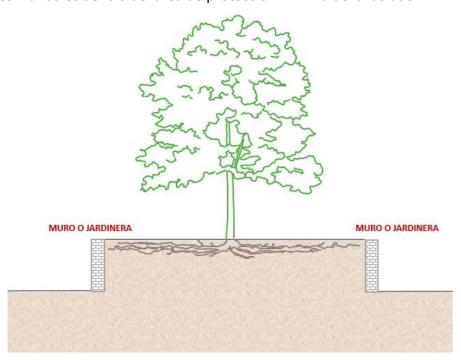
para proteger al árbol de un rebaje del terreno se debe construir un muro o jardinera.
